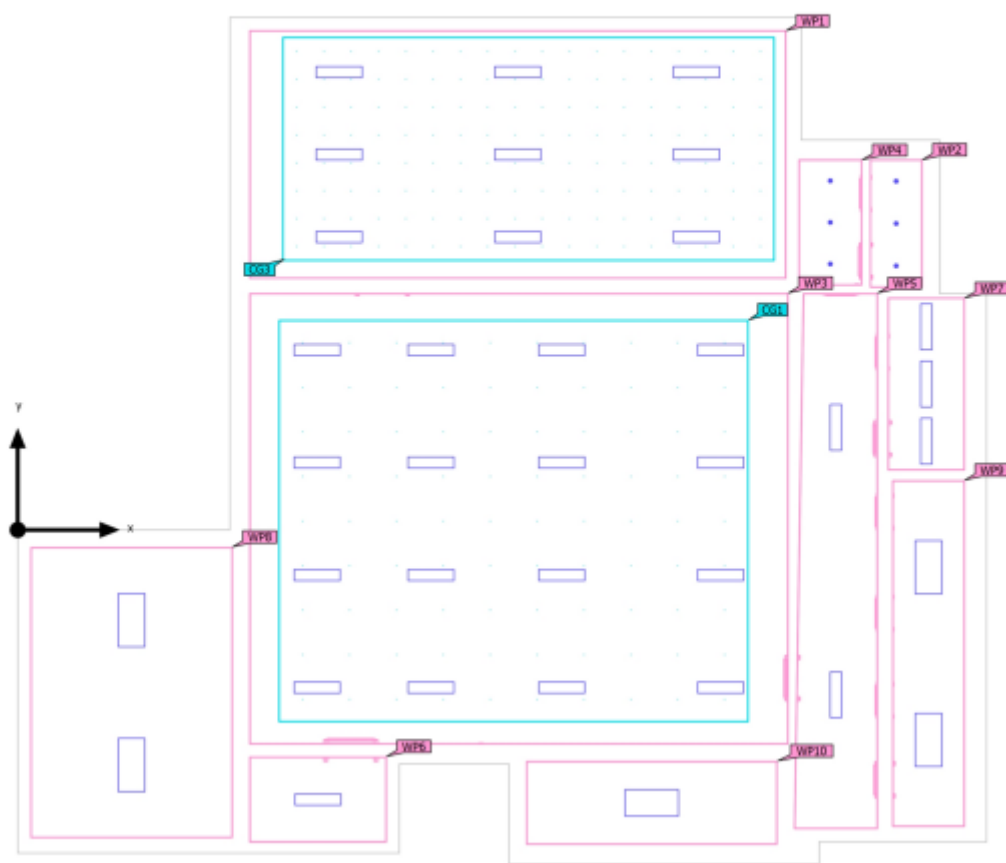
План будівлі магазину з розрахунковими поверхнями
